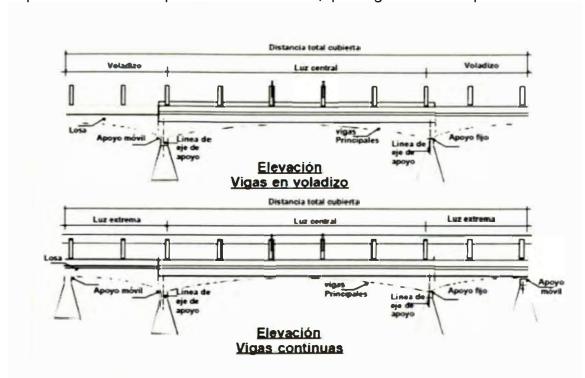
Tipos de estructuras que más se construyen en un proyecto civil.
